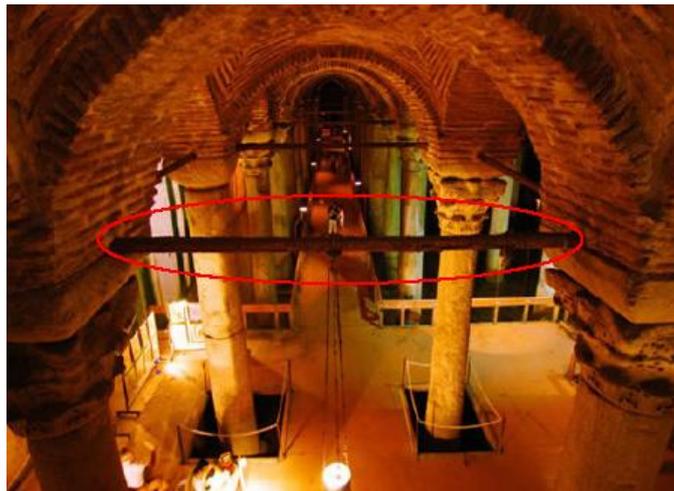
Perfil metálico chumbado na estrutura da Igreja de Santa Sofia em Estambul.
